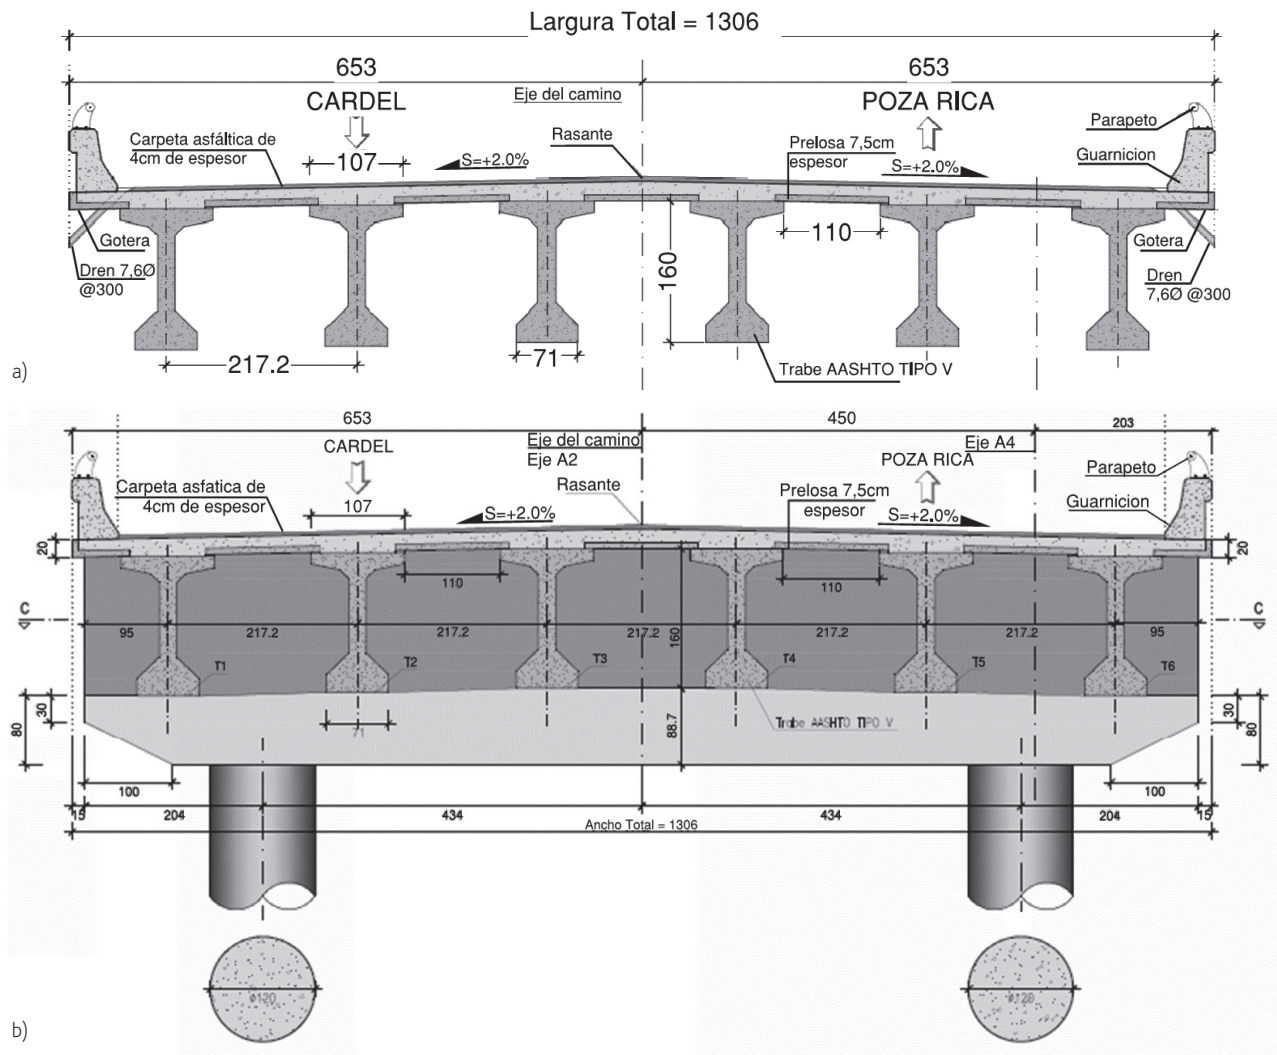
Corte transversal do tabuleiro numa: a) secção do vão; b) secção dos pilares [5]
